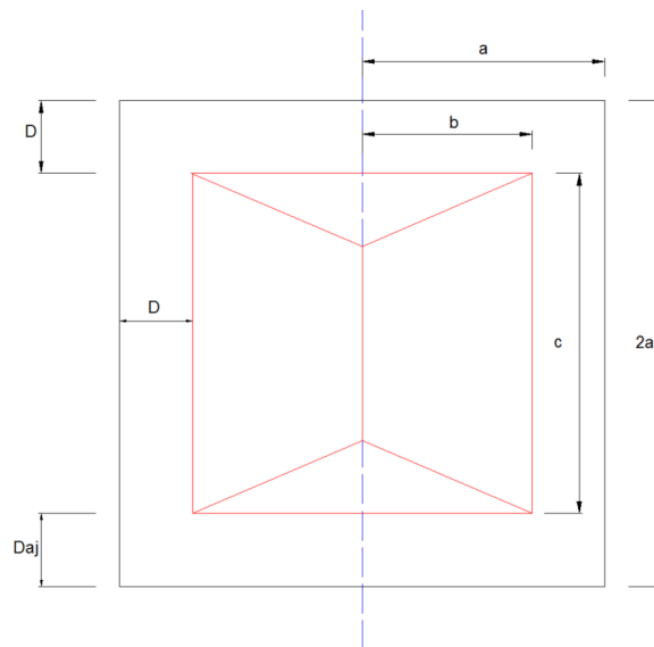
Casa tipo pareada con sus parámetros. Fuente: Elaboración propia.
